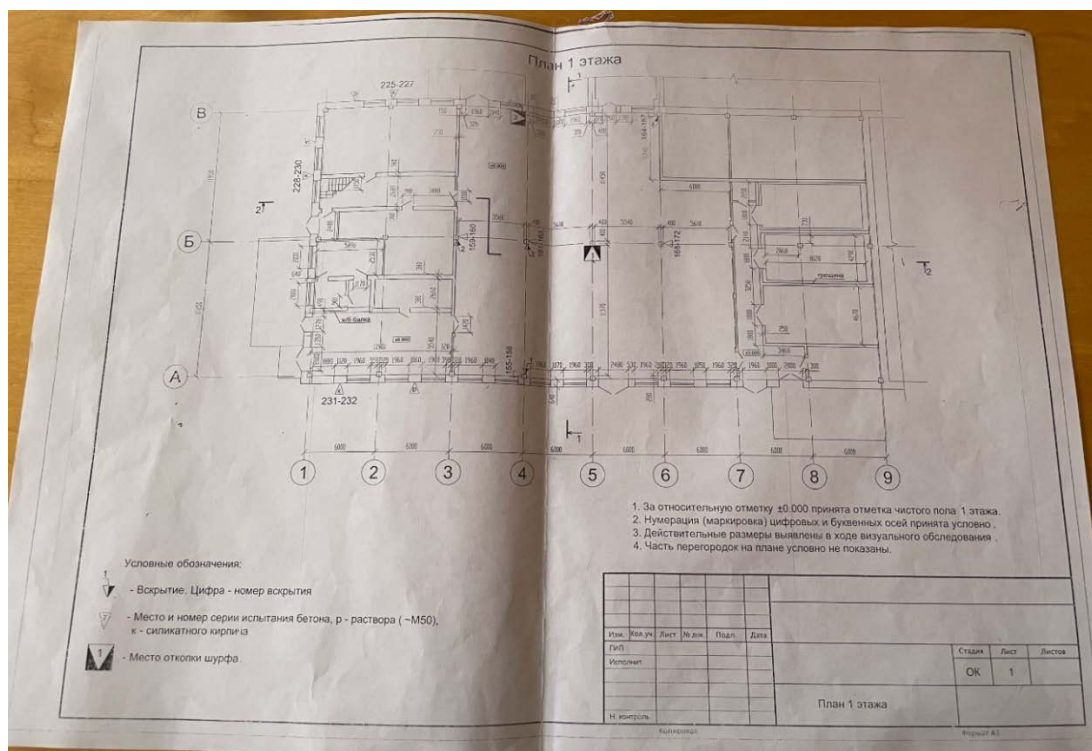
План 1 этажа жилого дома по адресу г. Киров, ул. Грибоедова, д. 30 с повреждениями (дефектами) (авторская разработка)
